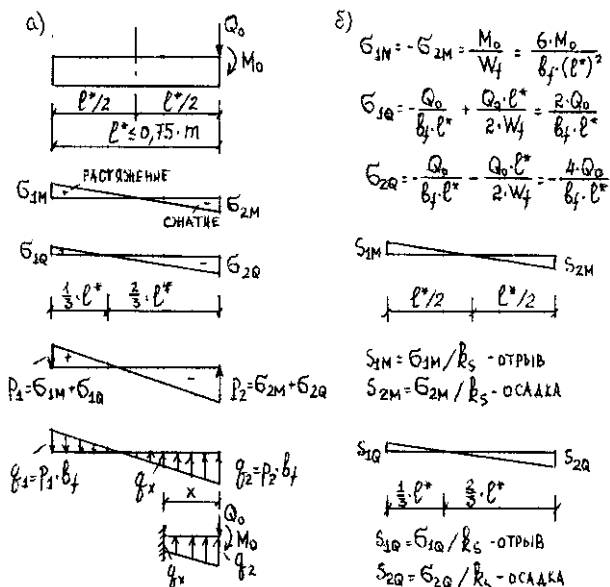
Расчёт жёстких балок: а – схемы нагружения, б – эпюры давления на грунт, отпора грунта и осадок
